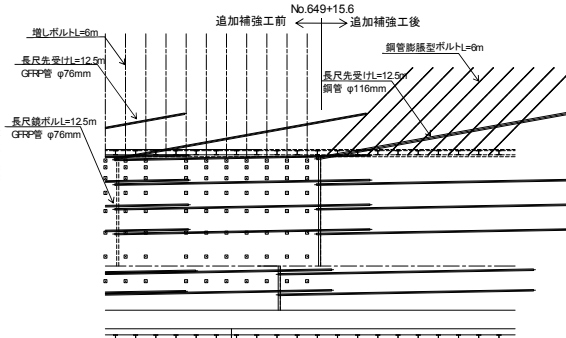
追加地山補強工を採用した施工パターン図(縦断面図)
